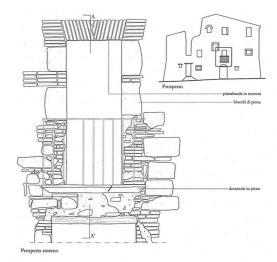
Albañilería mixta. Borgo Faraone (Te), casa campesina, detalles
